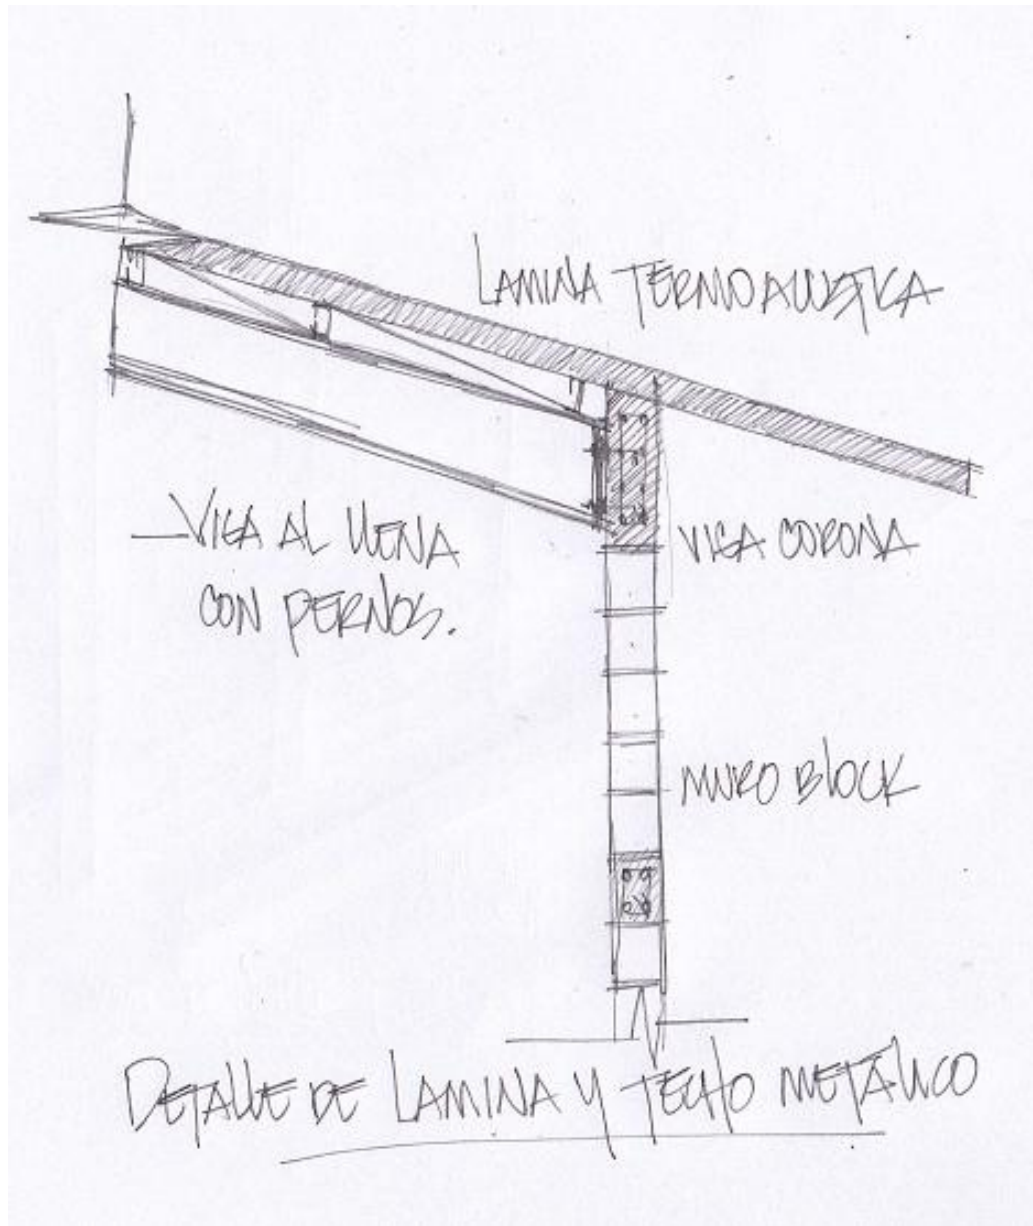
DETALLE DE LAMINA Y TECHO METÁLICO
